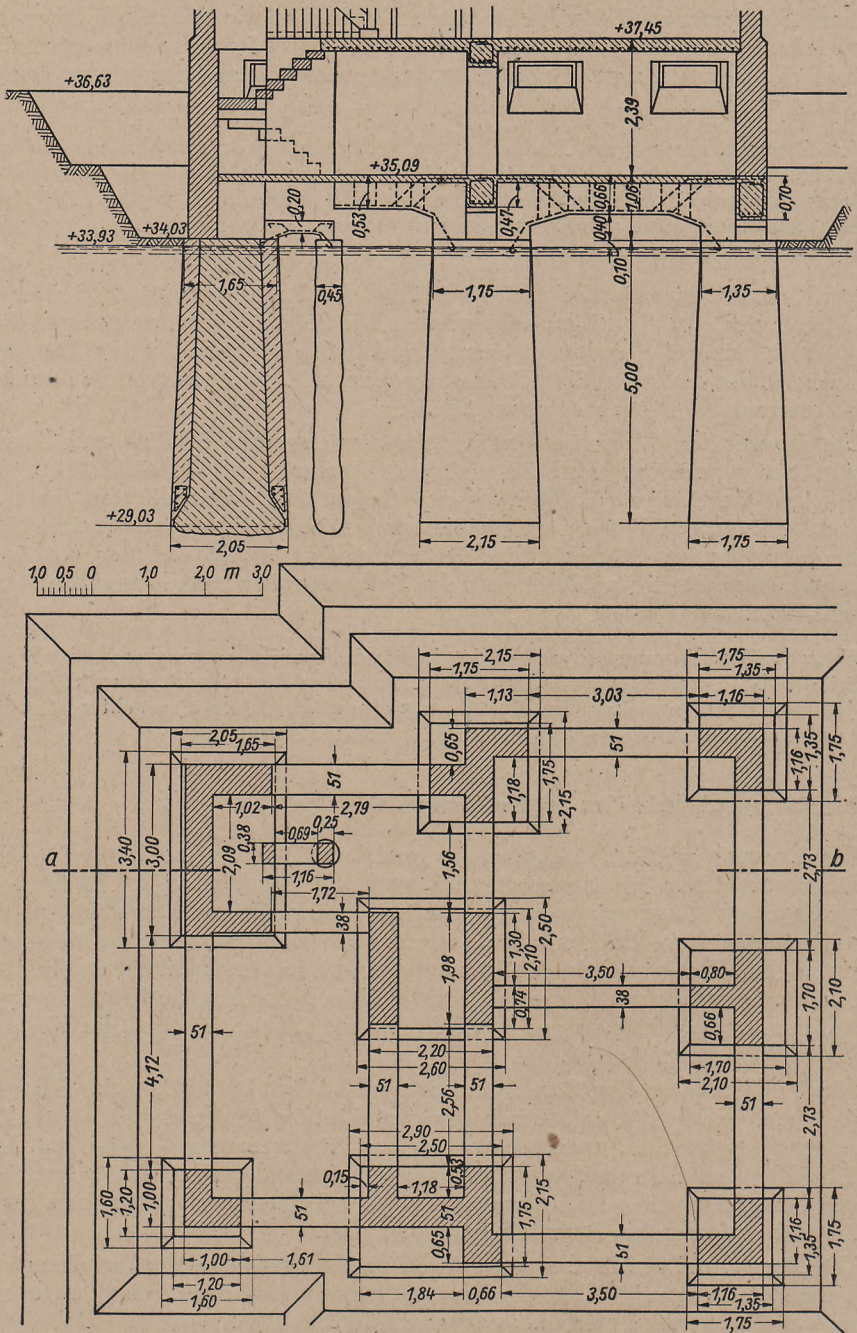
Gründung eines Wohnhauses auf Betonsenkrümmen mit verbindenden Stahlbetonbalken
